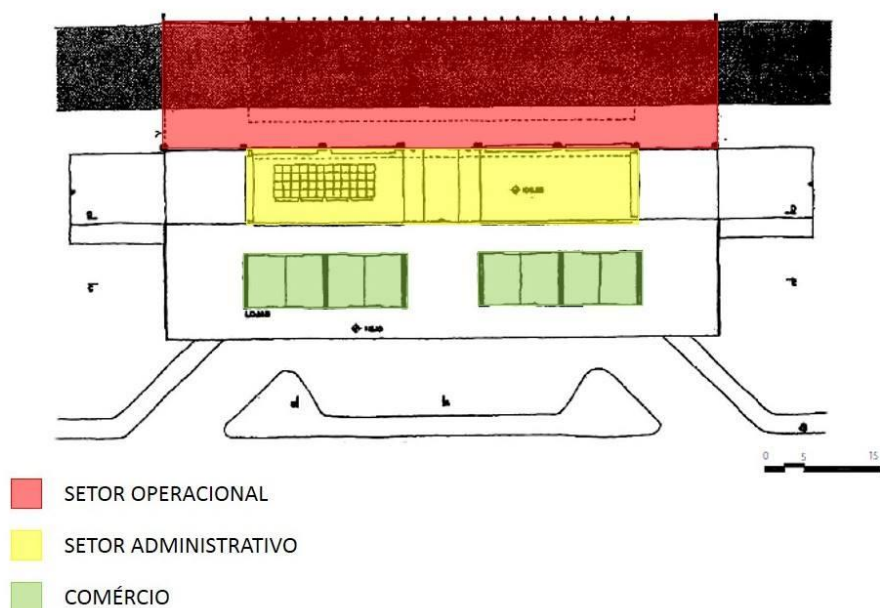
Planta pavimento intermediário. Fonte: Adaptado www.arquiteturabrutalista.com.br
